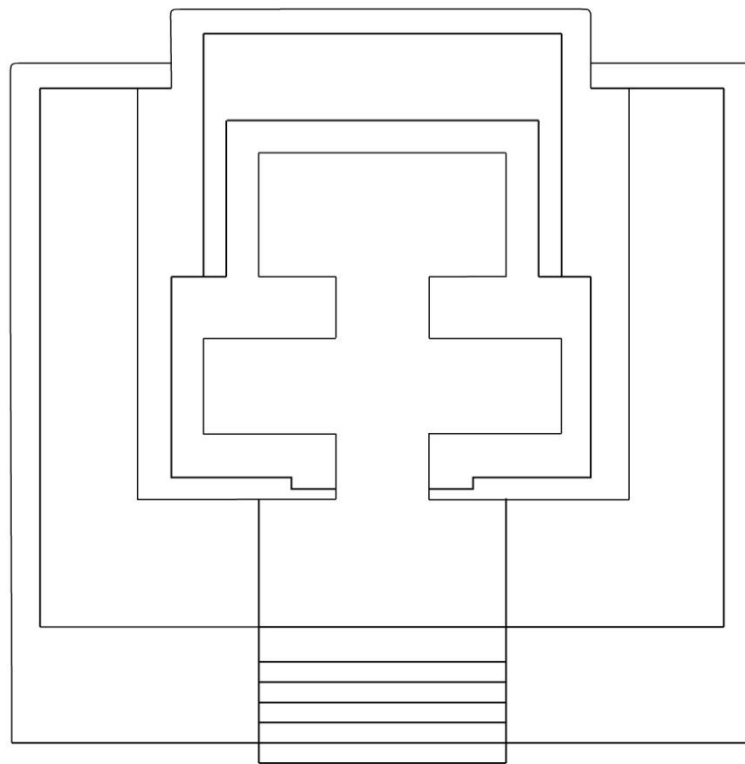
Reconstrucción hipotética de planta de la estructura G6-1 (PAEZ 2013).
